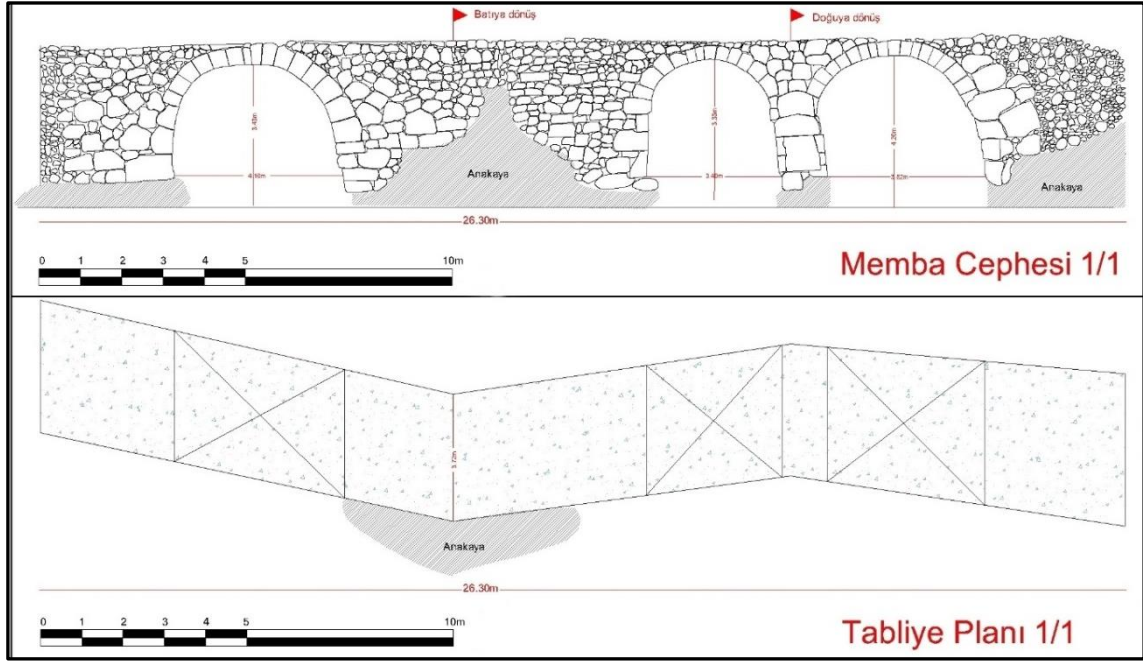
Eşek Köprüsü'nün memba cephesi ve plan çizimi
